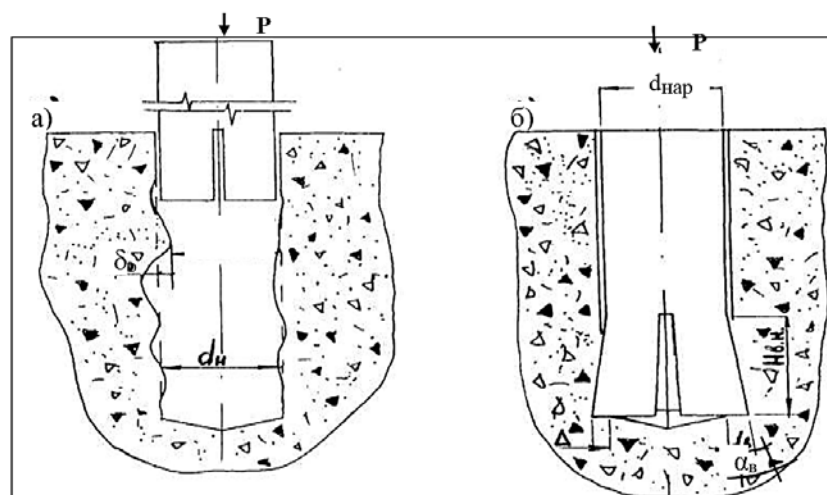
Схема установки (а) и расклинивания (б) конструкции типа I
